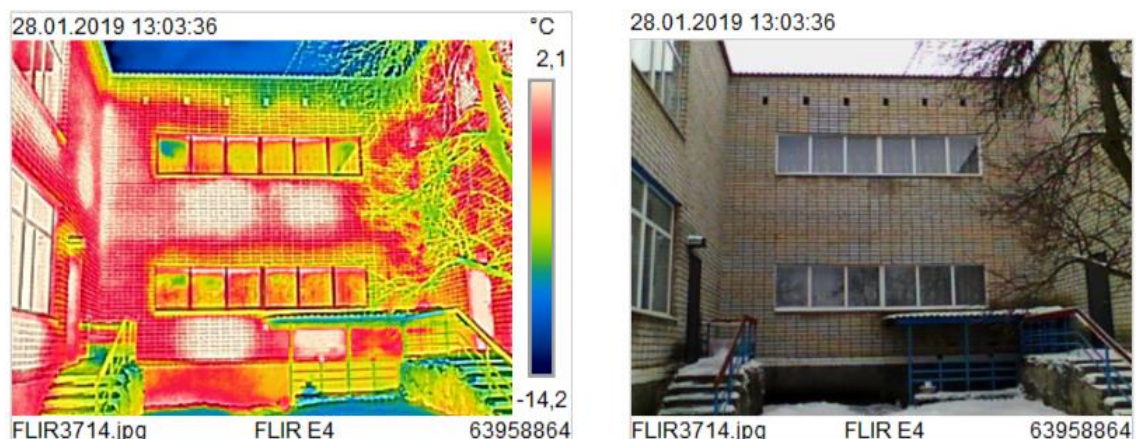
Термограма фрагменту фасаду будівлі ззовні
